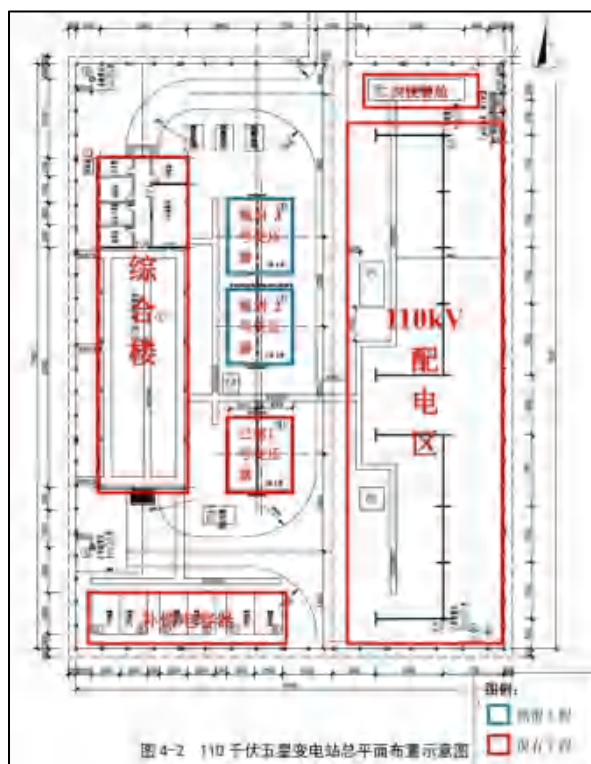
南阳新野 110 千伏五星变电站平面布置示意图
